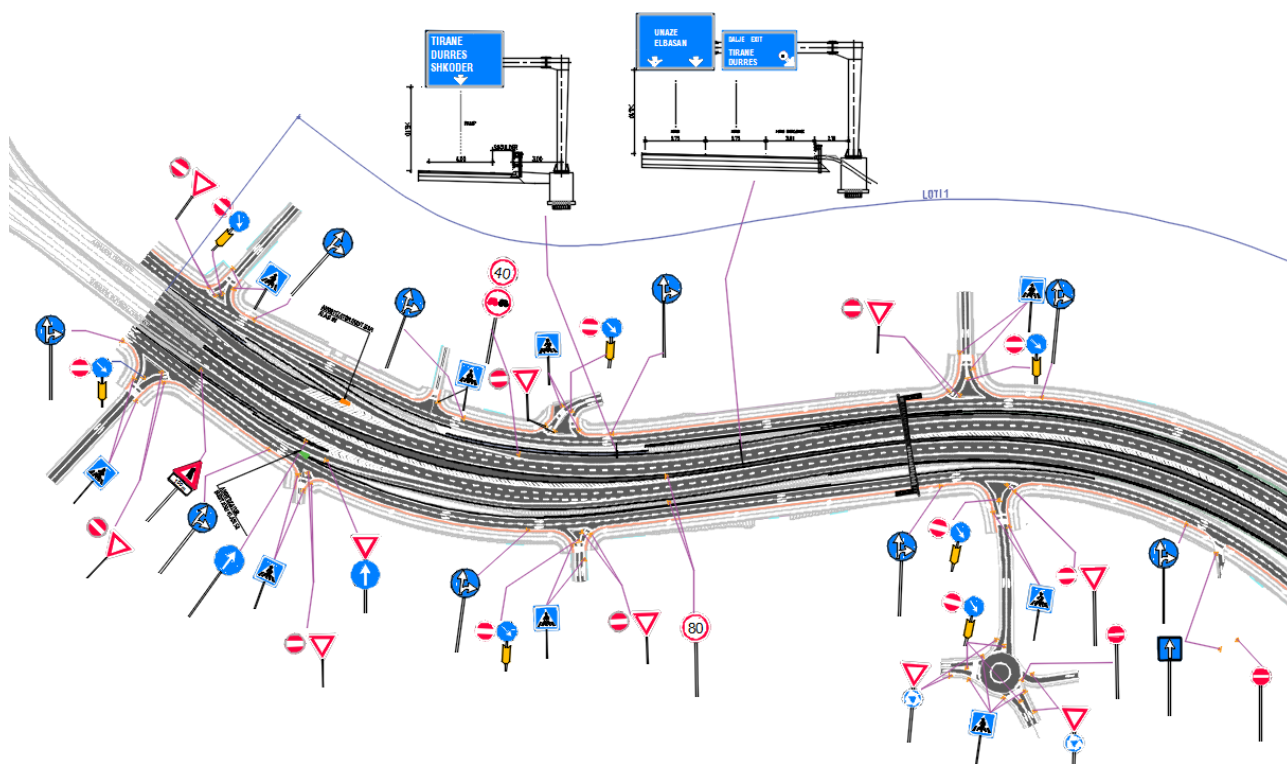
Fragment nga Planimetria e Sinjalistikes
